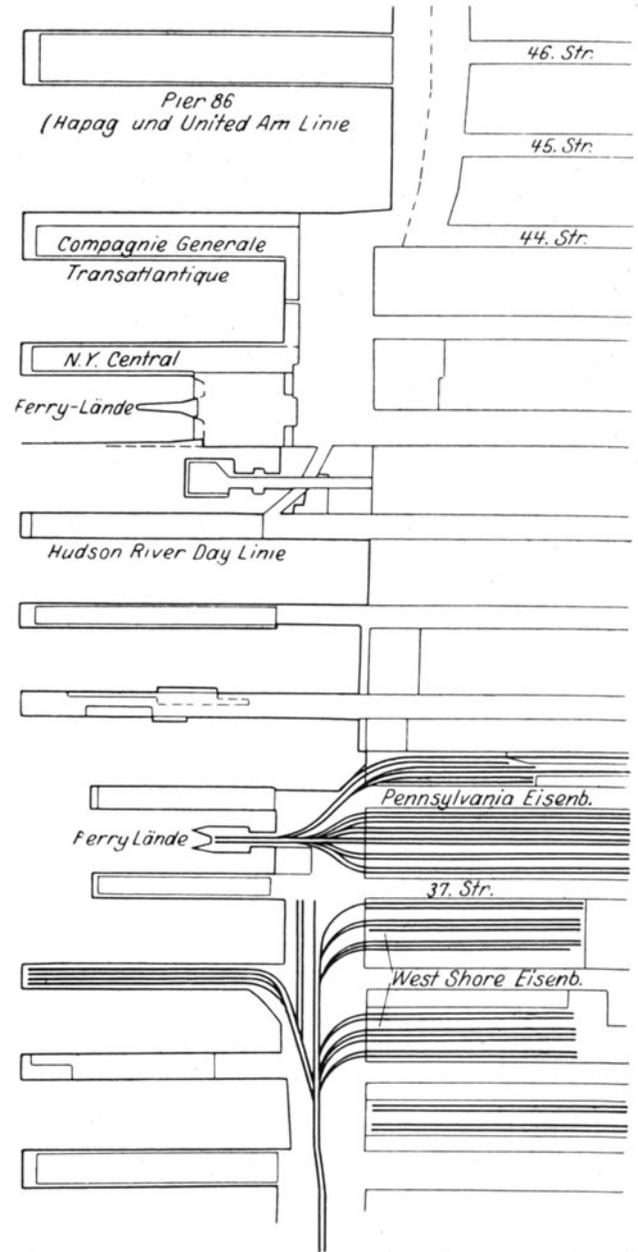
Piergruppe mit Pier 86. (Statt des Piers gegenüber der 44. Str. ist jetzt ein in seinen Ausmaßen dem Pier 86 ähnlicher vollendet.)
